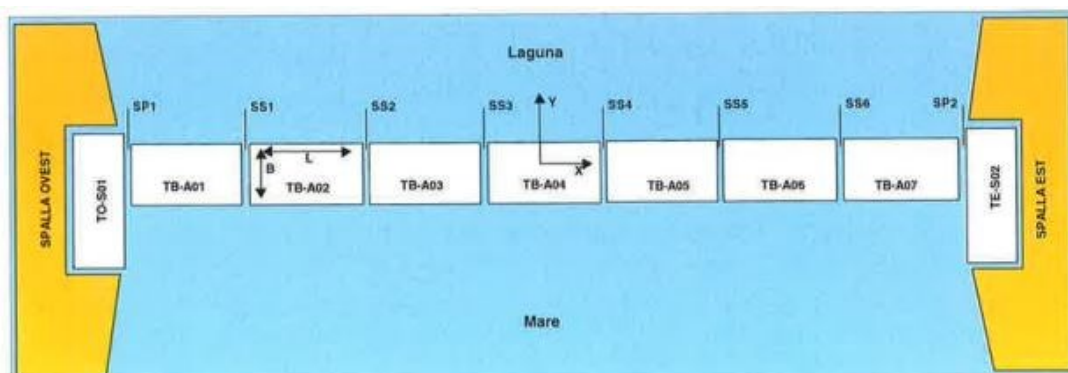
Rappresentazione in pianta della barriera di Treporti; estratto dagli elaborati grafici AS BUILT.
